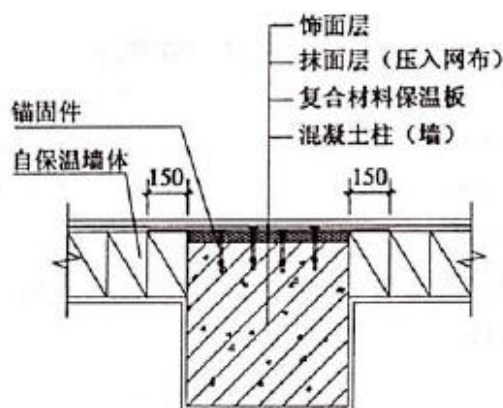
混凝土柱（墙）与自保温墙体连接平面构造
